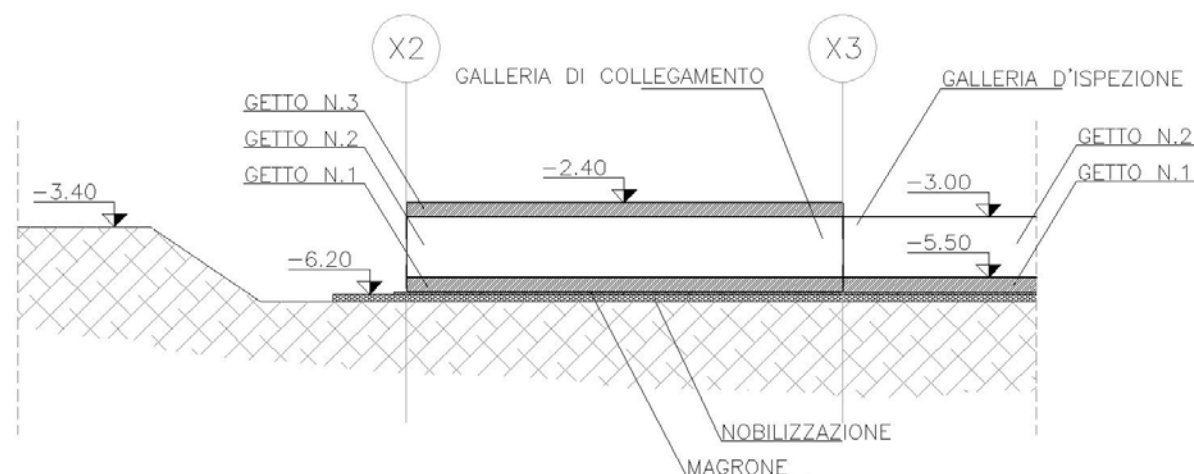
Sezione longitudinale galleria tecnica d'ispezione CdD e galleria di collegamento "galleria laterale"
